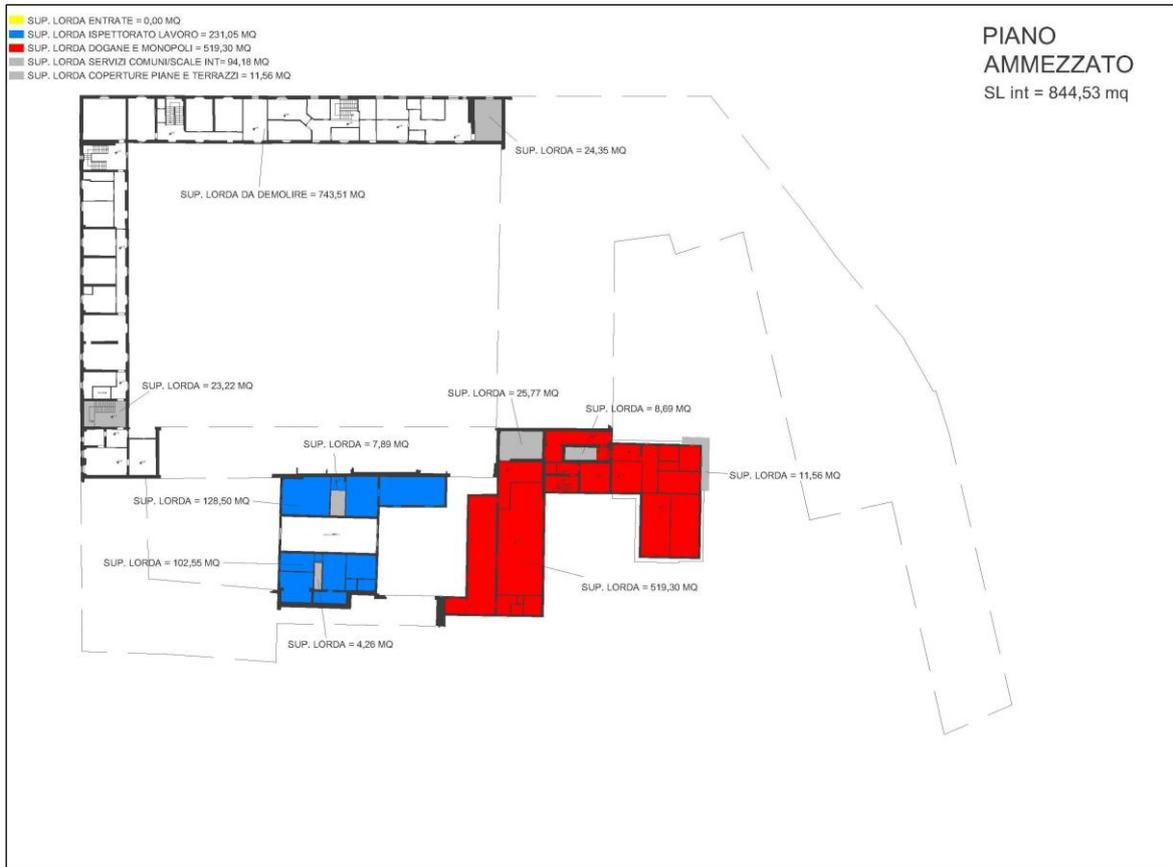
Piano di razionalizzazione (2019) – pianta del piano ammezzato
